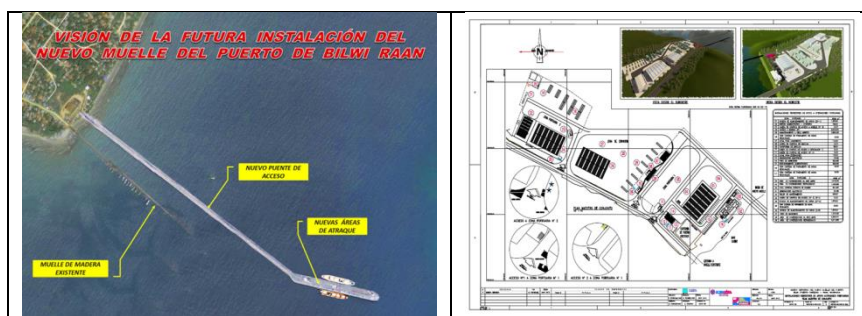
Plan del Nuevo Puerto de Bilwi
